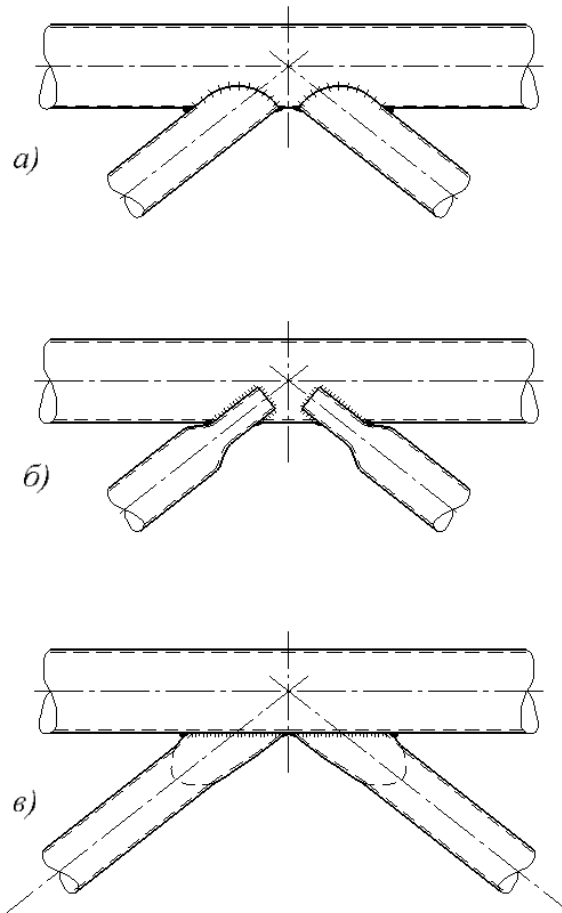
Варианты узлов легких ферм из круглых труб:
